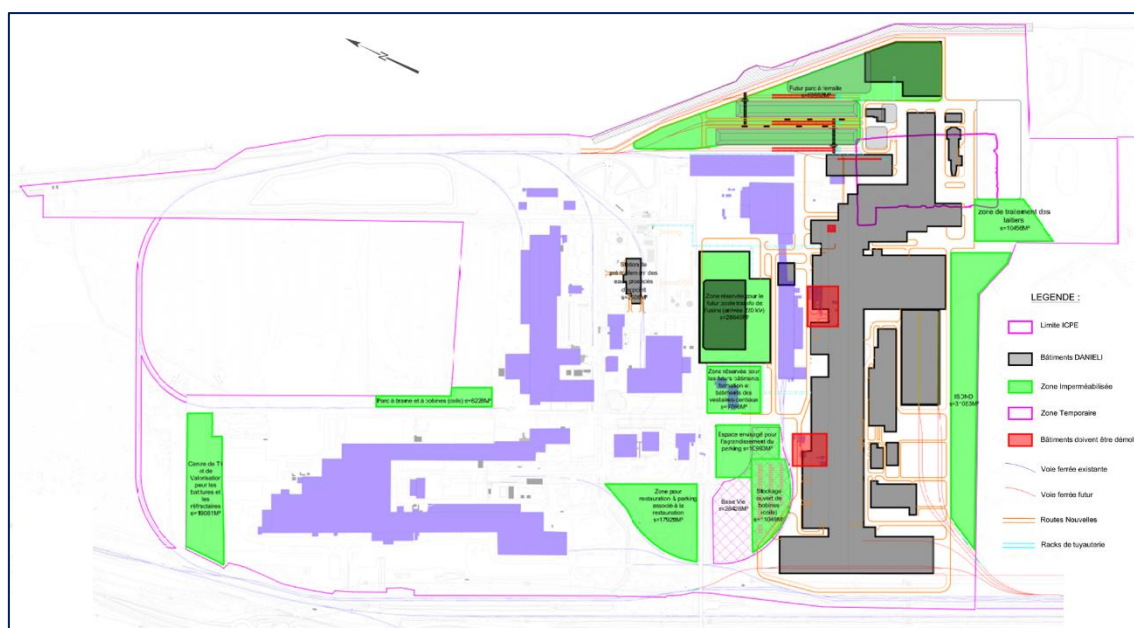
Plan d'implantation du projet Mistral (source : Tractebel Engie)
